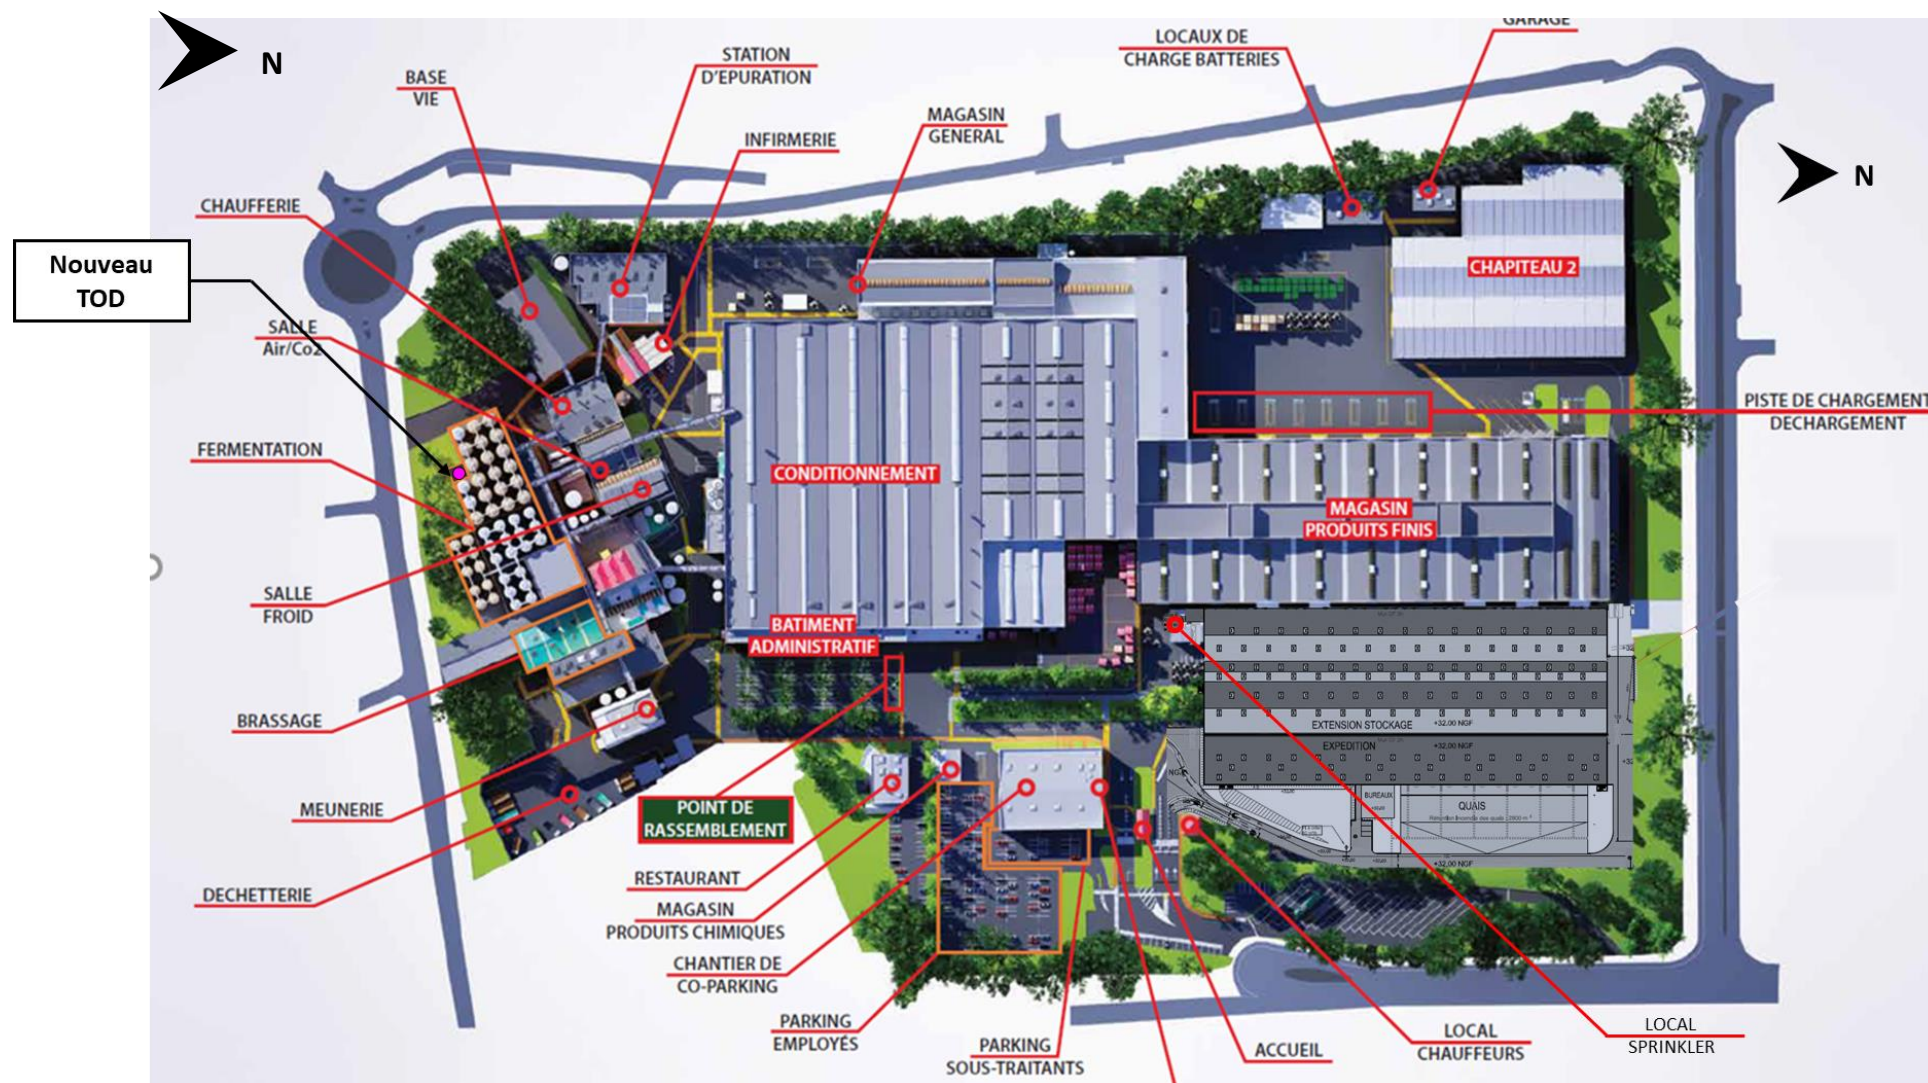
Plan simplifié du site de Mons-en-Barœul - état actuel (source : Heineken Entreprise)
